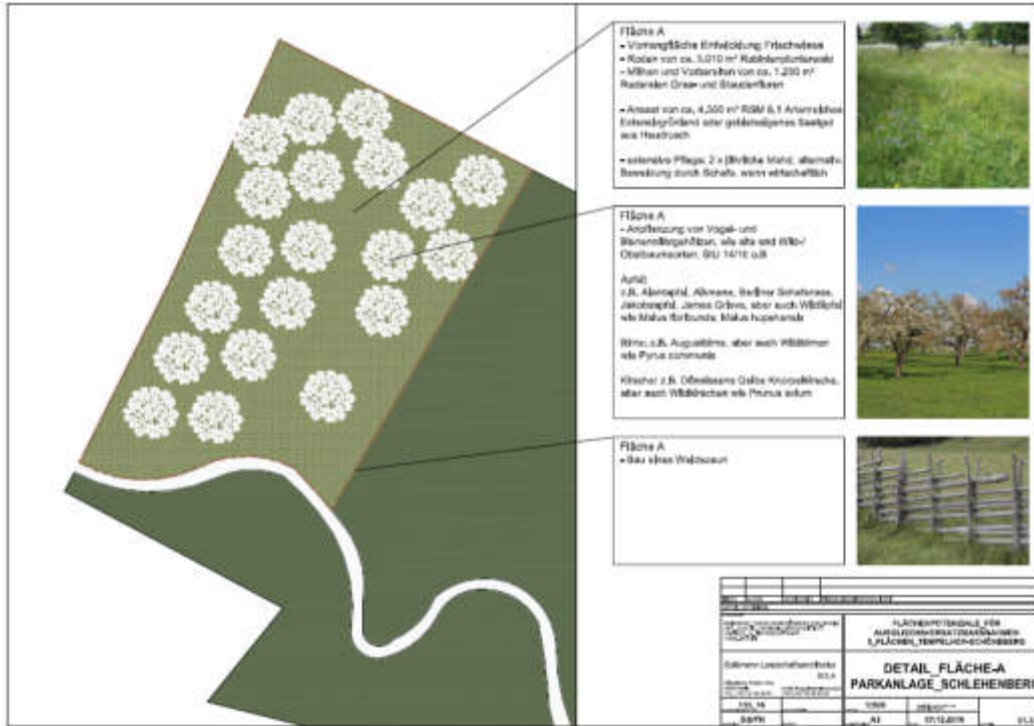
Detail Fläche A, Parkanlage Schlehenberg (Verkleinerung)
